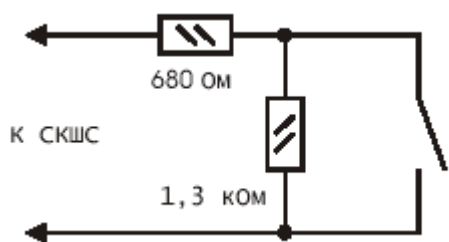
Типовая схема включения ШС с контролем КЗ и обрыва
